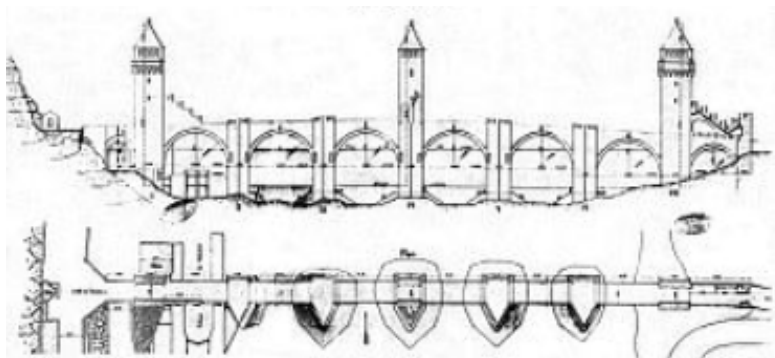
Plan și elevație a Pont Valentré, 1896/Plan and elevation of Pont Valentré, 1896
